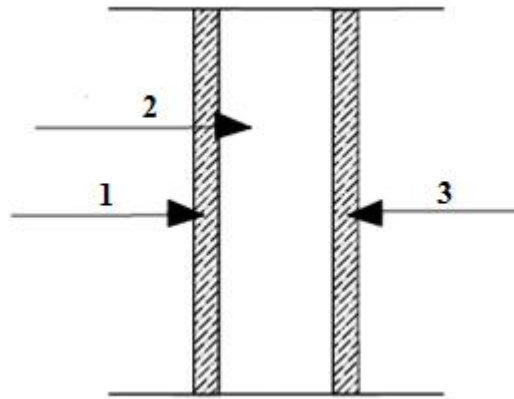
Coupe verticale revenant au mur extérieur.
